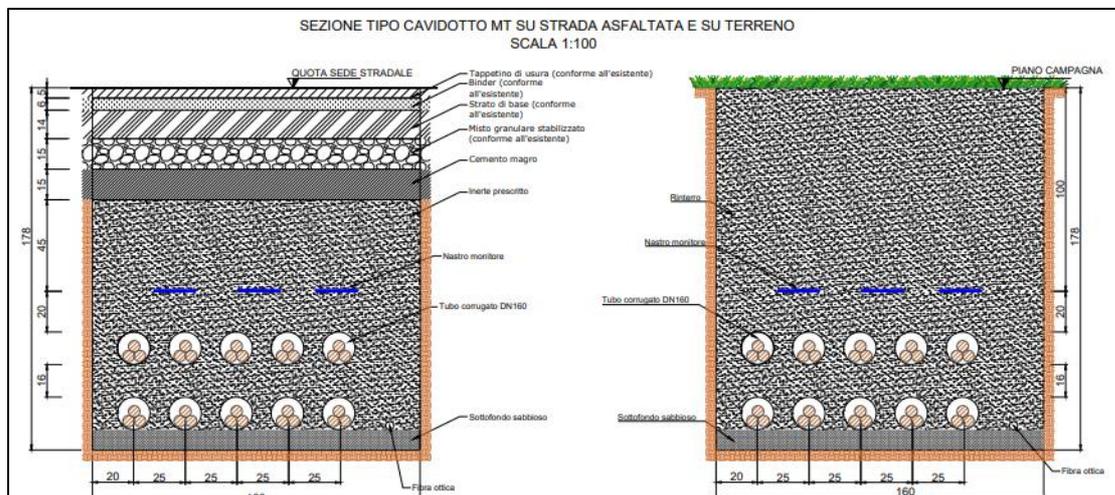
Sezione tipo cavidotto MT su strada asfaltata e su terreno
